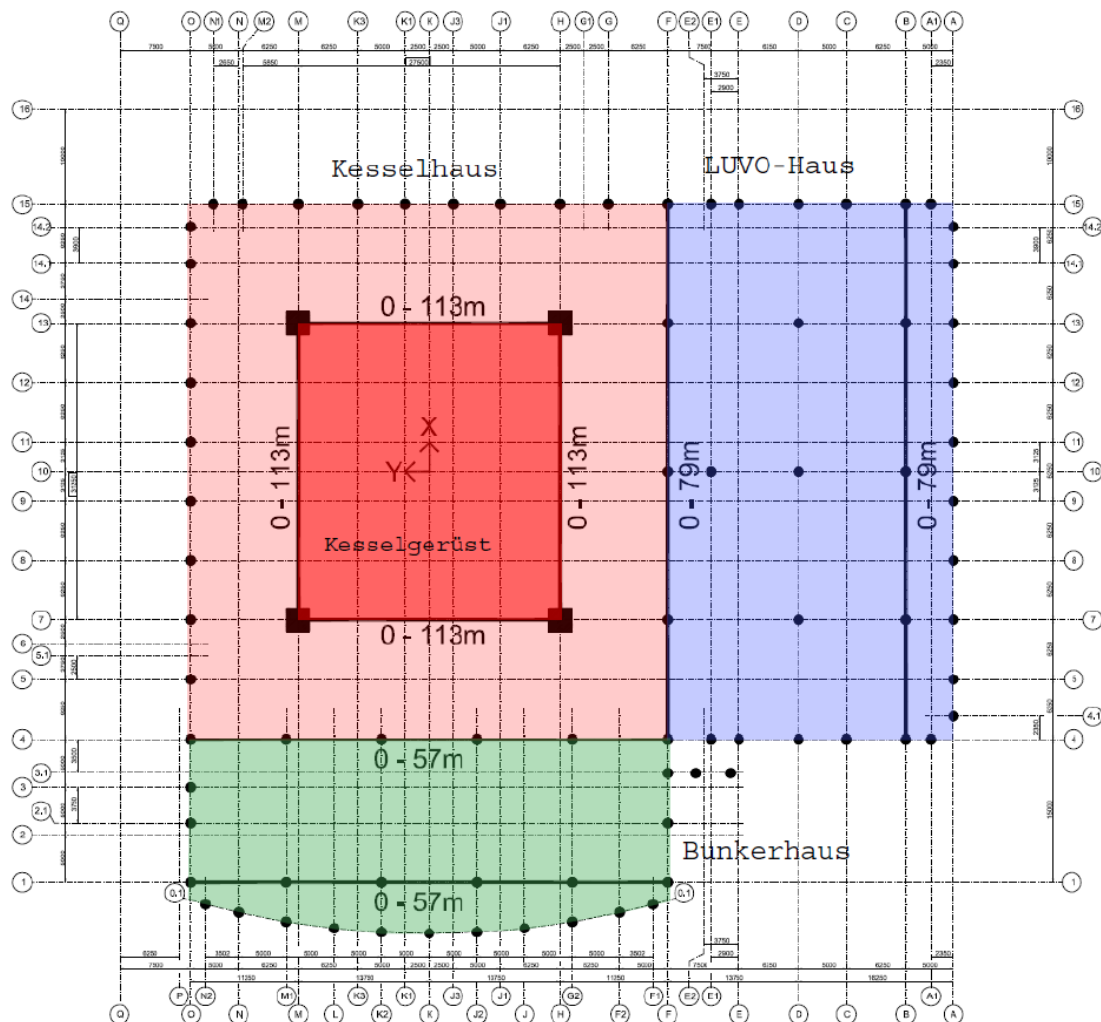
Grundriss Kraftwerk Maasvlakte (siehe statische Berechnungen Anlage G)
